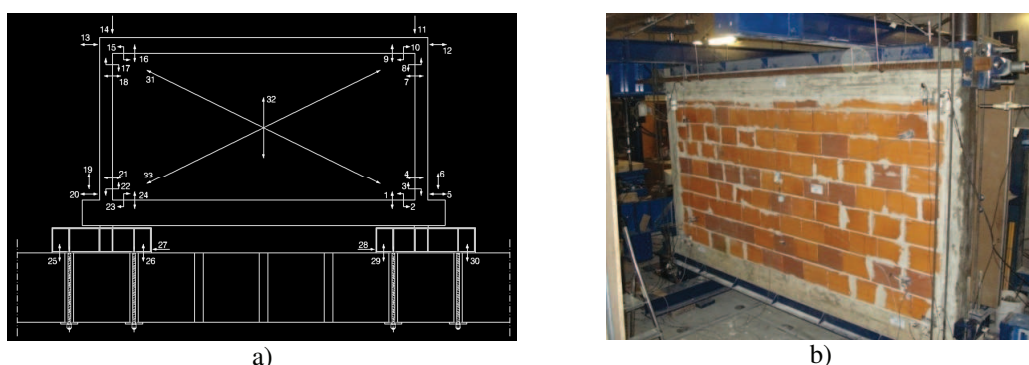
Instrumentação no plano: a) Esquema; b) Vista geral.
